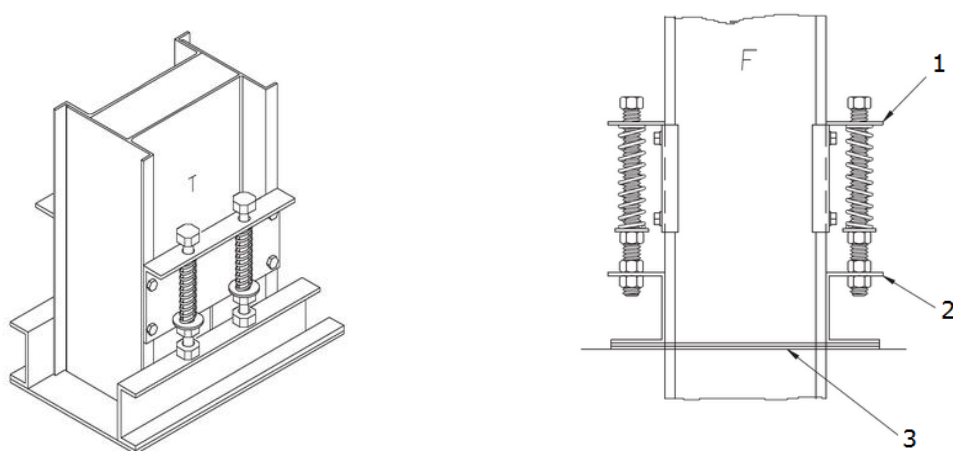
Схема вертикального крепления шинопровода: 1 – пружинный держатель; 2 – подставка; 3 – пластины закрывающие отверстие этажного перекрытия.
